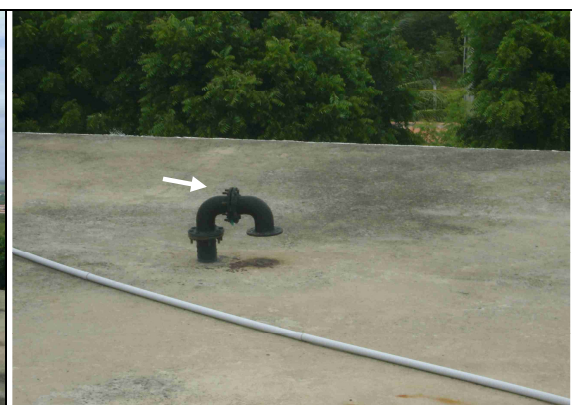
RAP-01: Tubulação de ventilação com tela de proteção.
